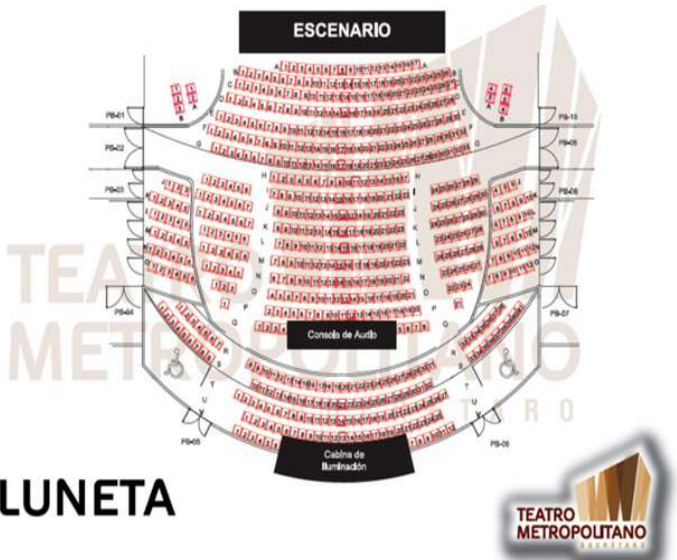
PLANO DE LA SALA PRINCIPAL LUNETA. FUENTE: <http://qcc.mx/es/instalaciones/planos/2/qtm/>
